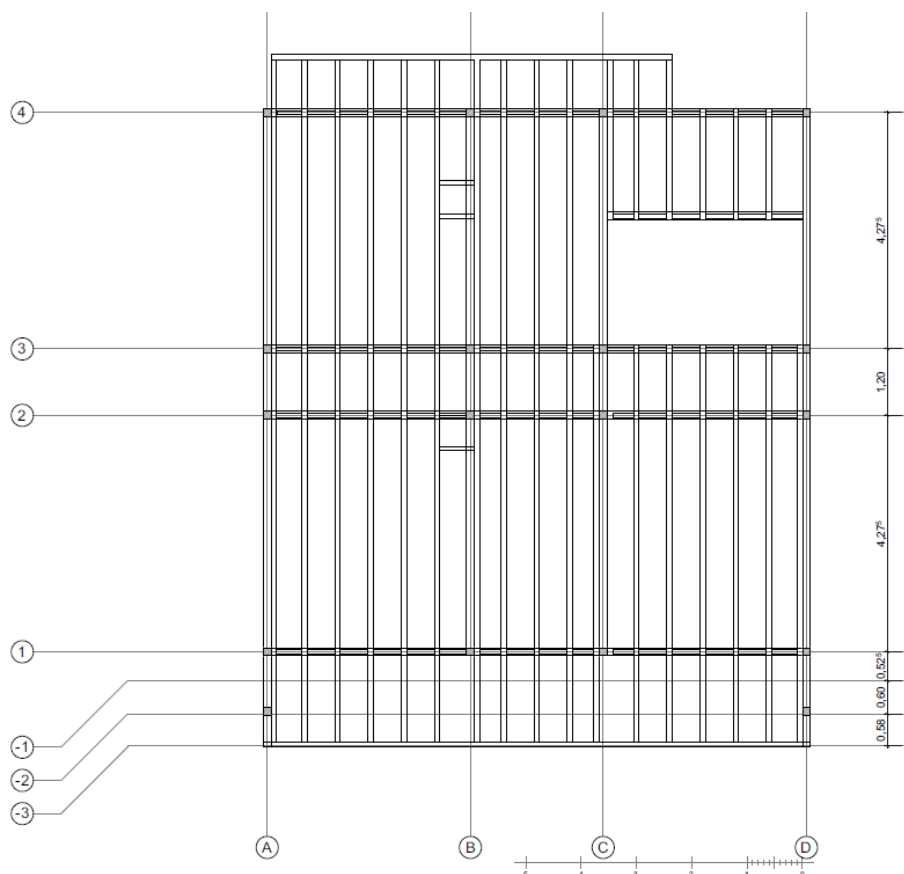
Planta da estrutura do pavimento do piso 1.
